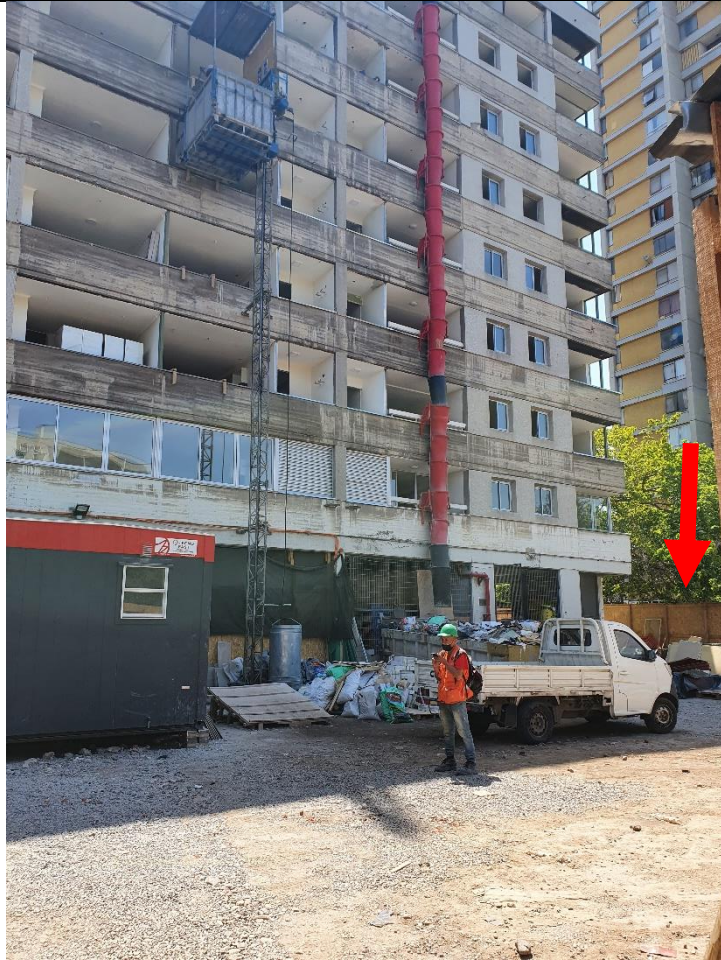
Vista faena constructiva. – Fuente: inspección en terreno 23/12/2021.
